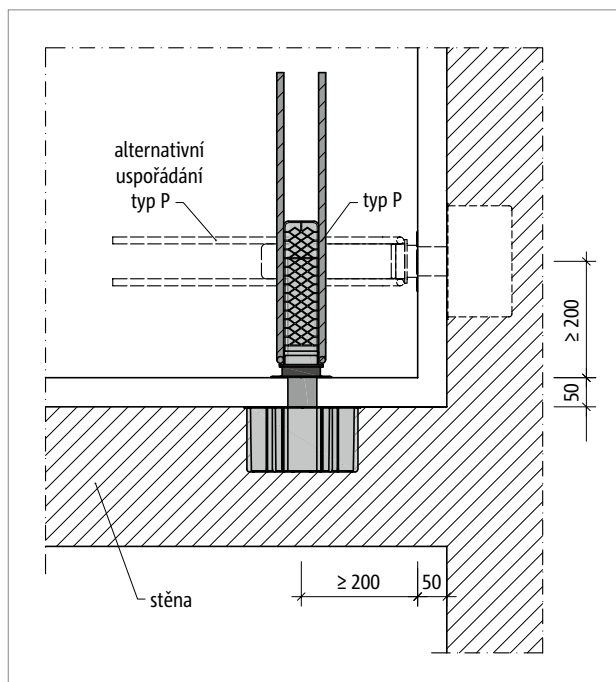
Schöck Tronsole® typ P: Uspořádání prvků, detail A, tloušťka spáry $b = 15 \text{ mm}$ u monolitických konstrukcí; u prefabrikovaných schodišťových ramen musí projektant ověřit, zda není nutno uvažovat s přidavnou montážní tolerancí
